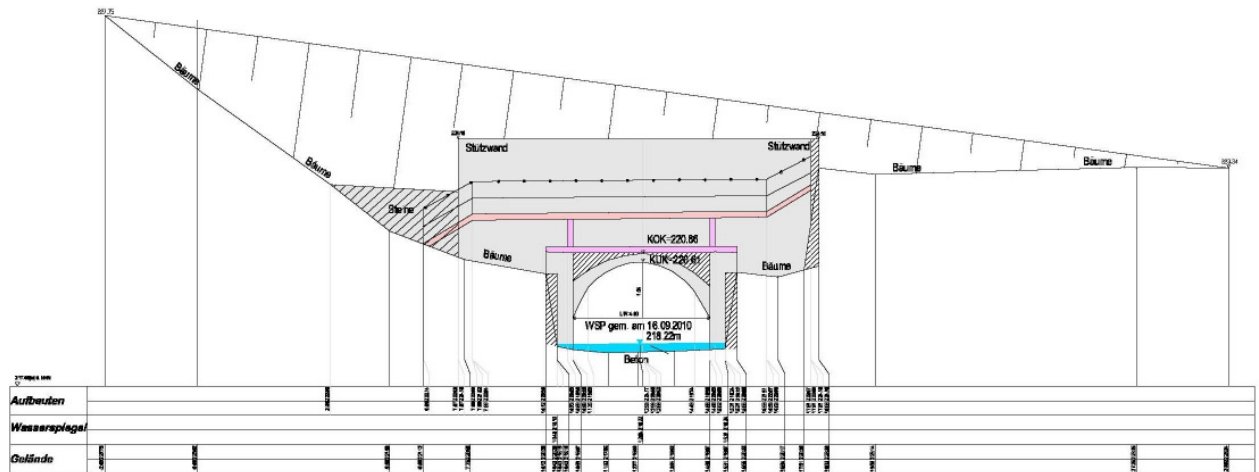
Einlaufbauwerk Ilsetunnel /5/
